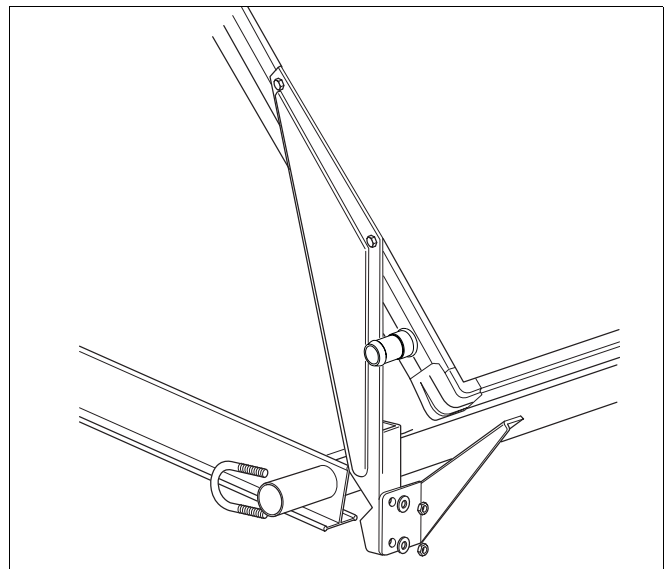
Kollektorhalter unten an Rundprofil montieren
